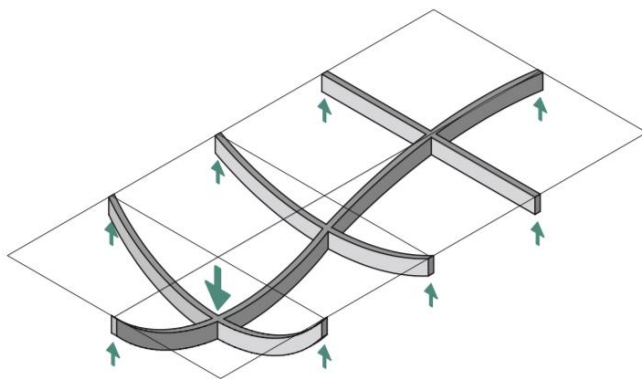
Respuesta estructural de un forjado bidireccional
